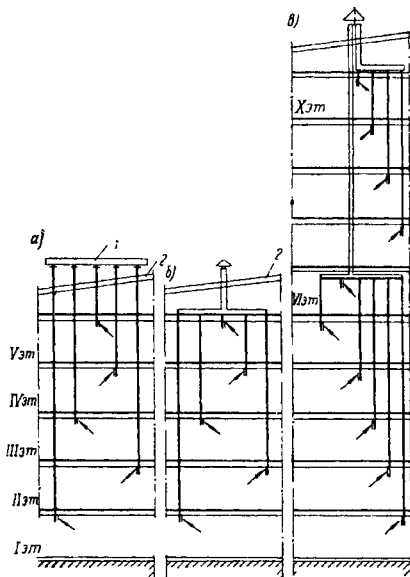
Схемы устройства вентиляционных каналов в многоэтажных жилых домах (5—10 этажей)
